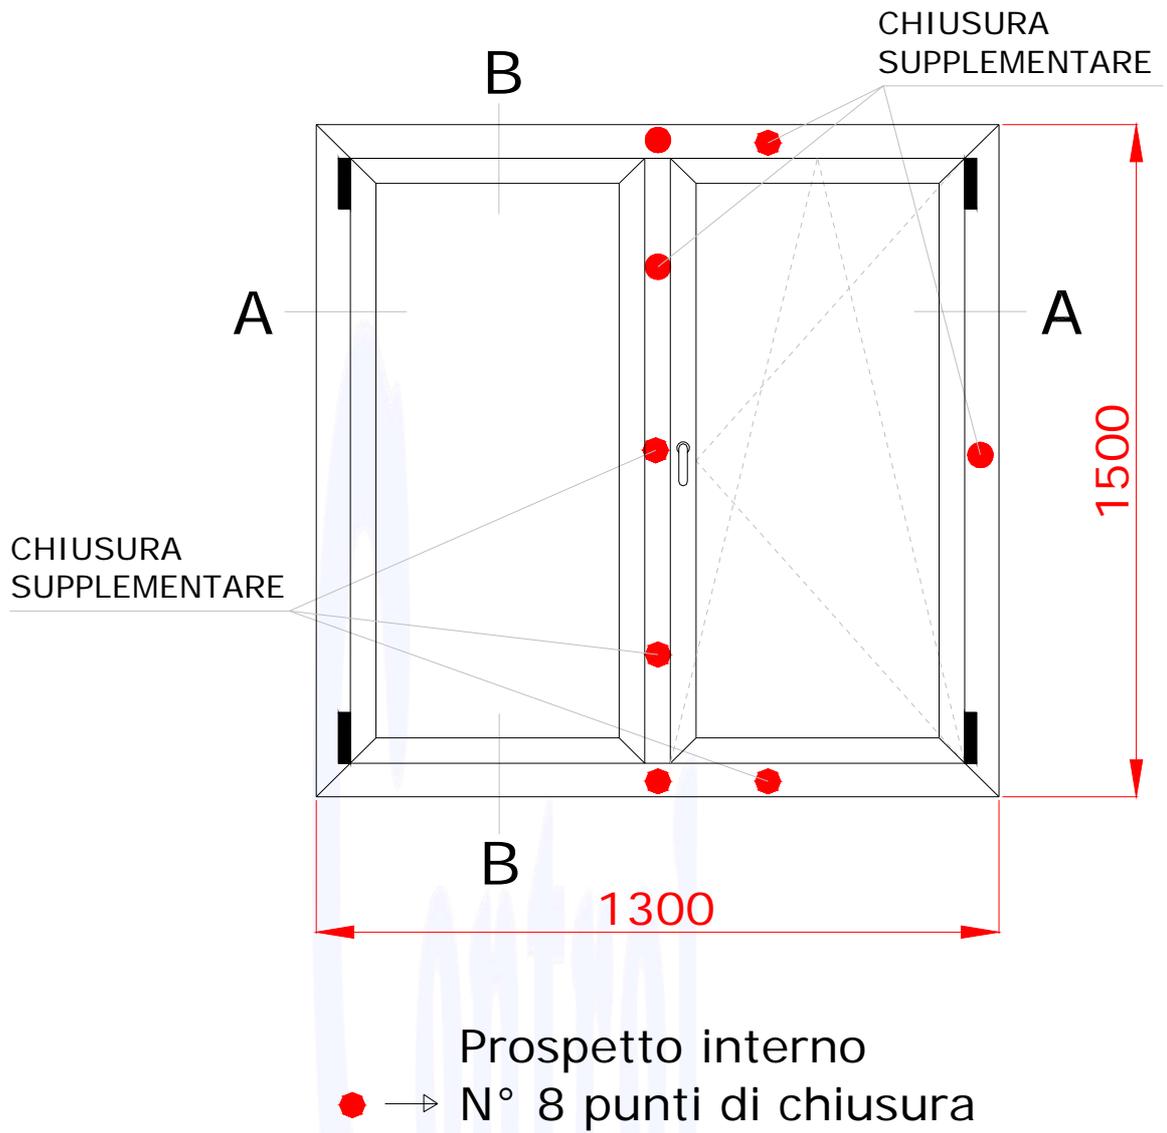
Prospetto del campione pervenuto e sottoposto a prova
